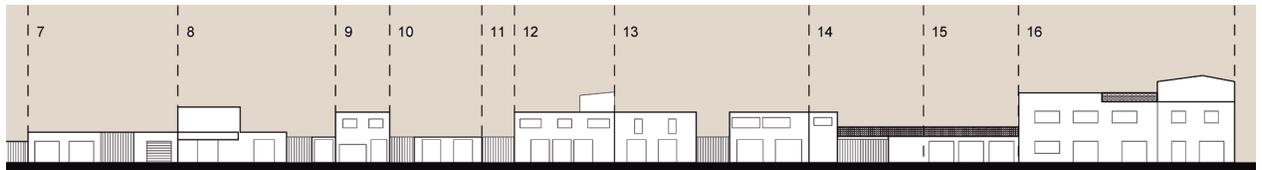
Sección de paramento de lotes de dimensiones variables. Calle División del norte. Fuente: Elaboración propia
